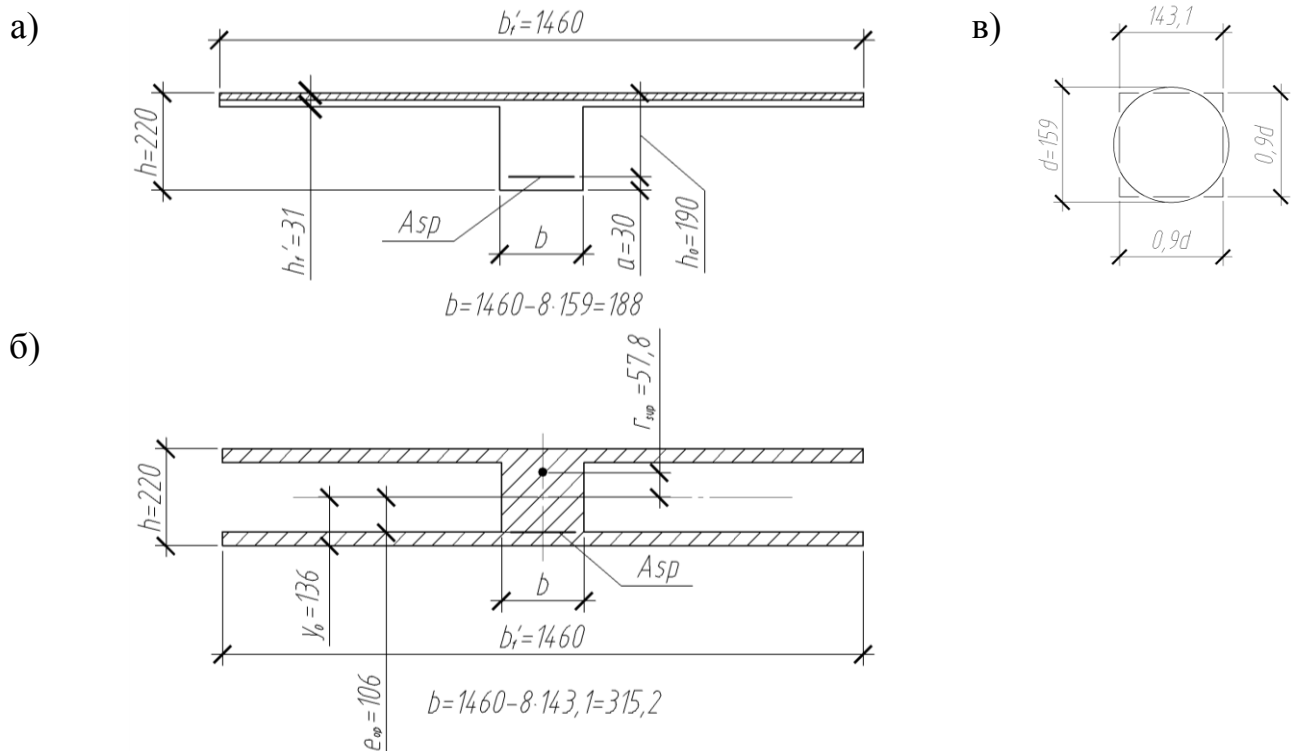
Поперечные сечения плиты с круглыми пустотами
